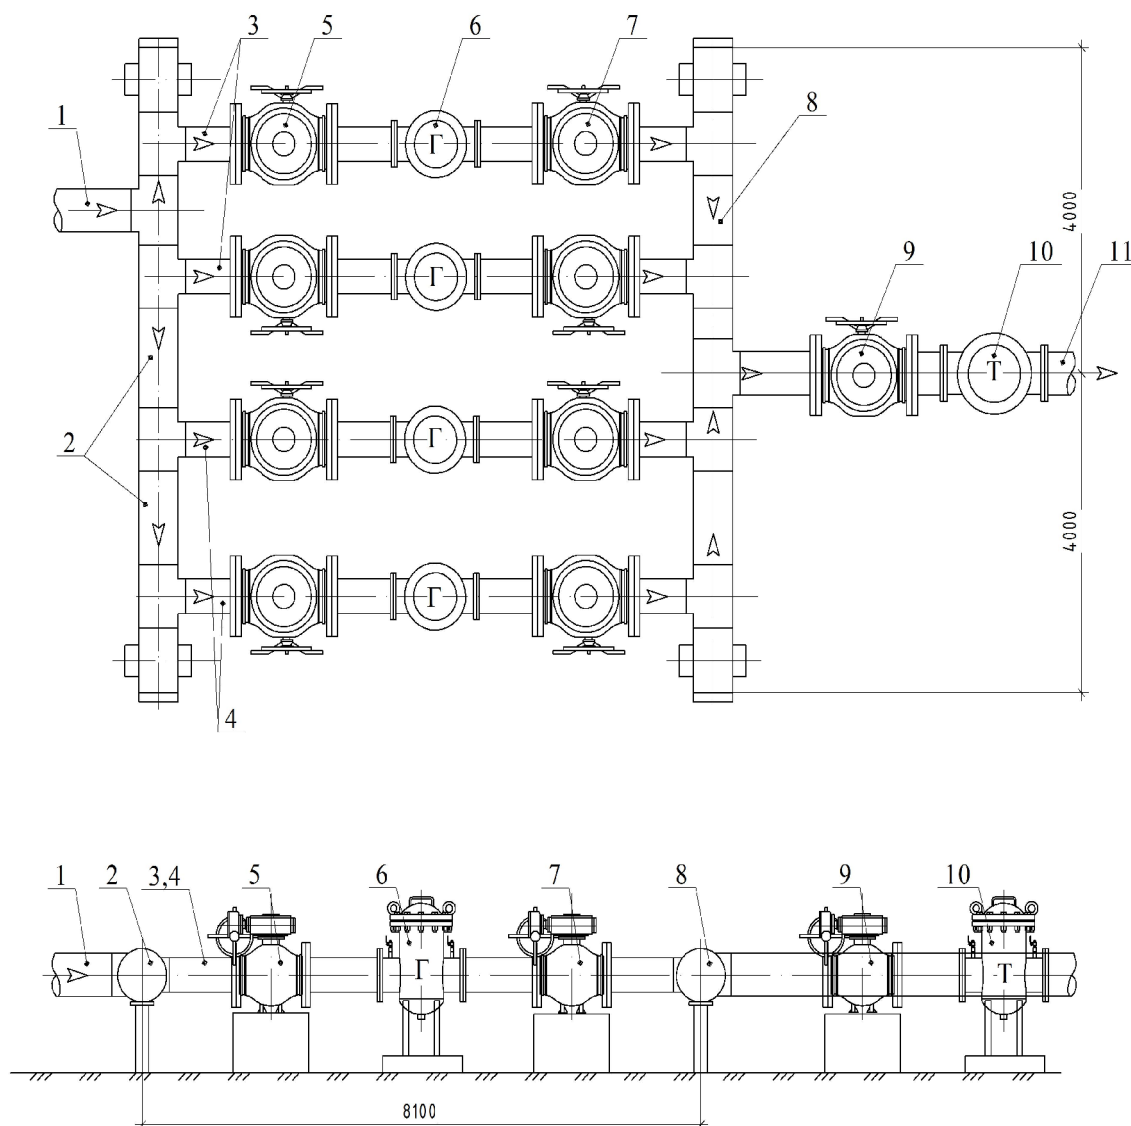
План и разрез узла из двух параллельно соединенных рабочих и двух резервных установок грубой очистки для головного ГРП:
